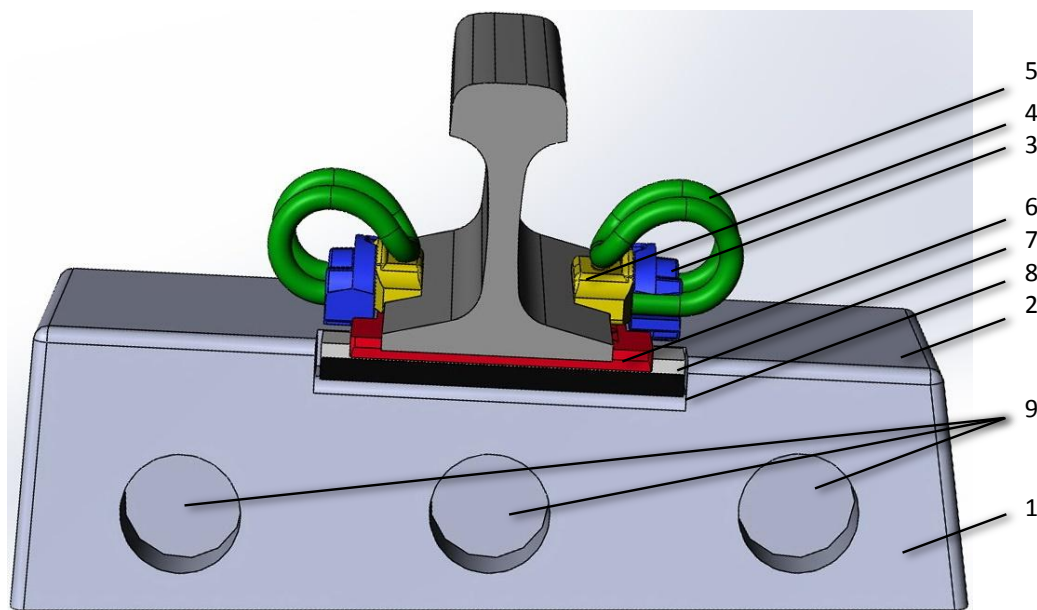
Устройство бетонного блока БОМ-В: 1 – монолитный армированный железобетонный блок, переменный по длине сечения; 2 – наклонная часть (подуклонка рельсовой площадки) блока опорного; 3 – анкер; 4 – изолятор; 5 – клемма пружинная; 6 – подрельсовая прокладка; 7 – набор виброгасящих прокладок; 8 – выемка для установки набора виброгасящих прокладок; 9 – выемка для бетонирования и удержания от вырывания блока опорного
